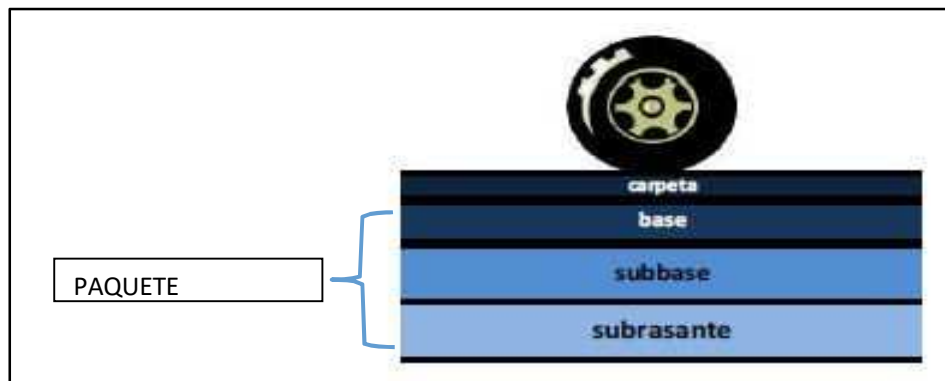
Estructura del pavimentado flexible. (Vásquez, 2002)
